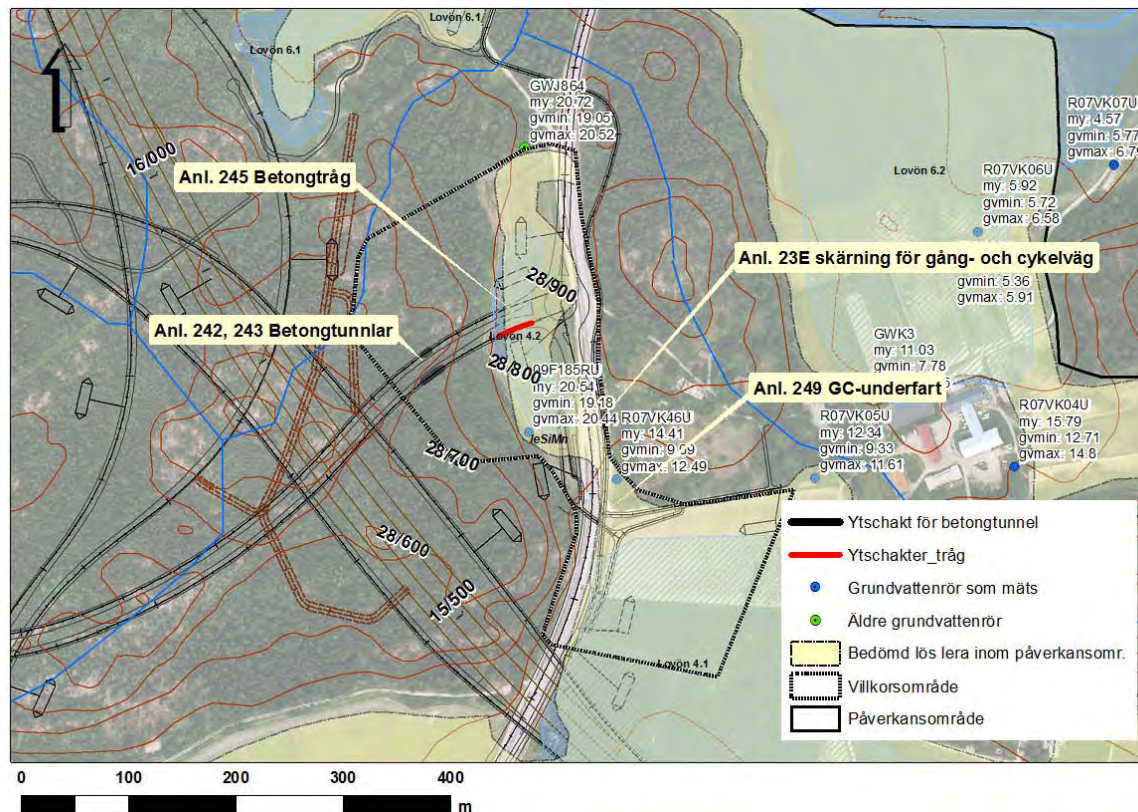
Kartfigur över betongtråg och betongtunnel vid anslutningen mot E20 till och från Stockholm.
